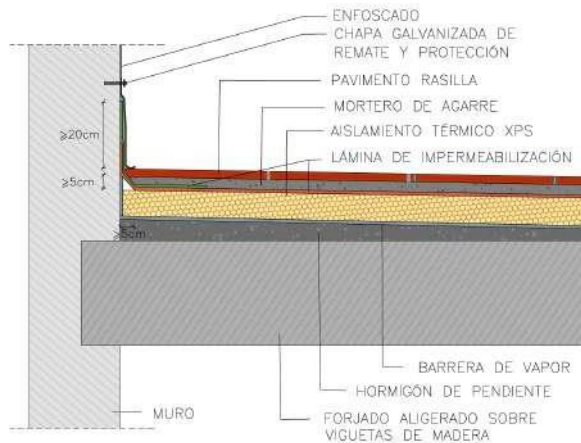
Propuesta de intervención de la cubierta del altillo. Fuente propia
